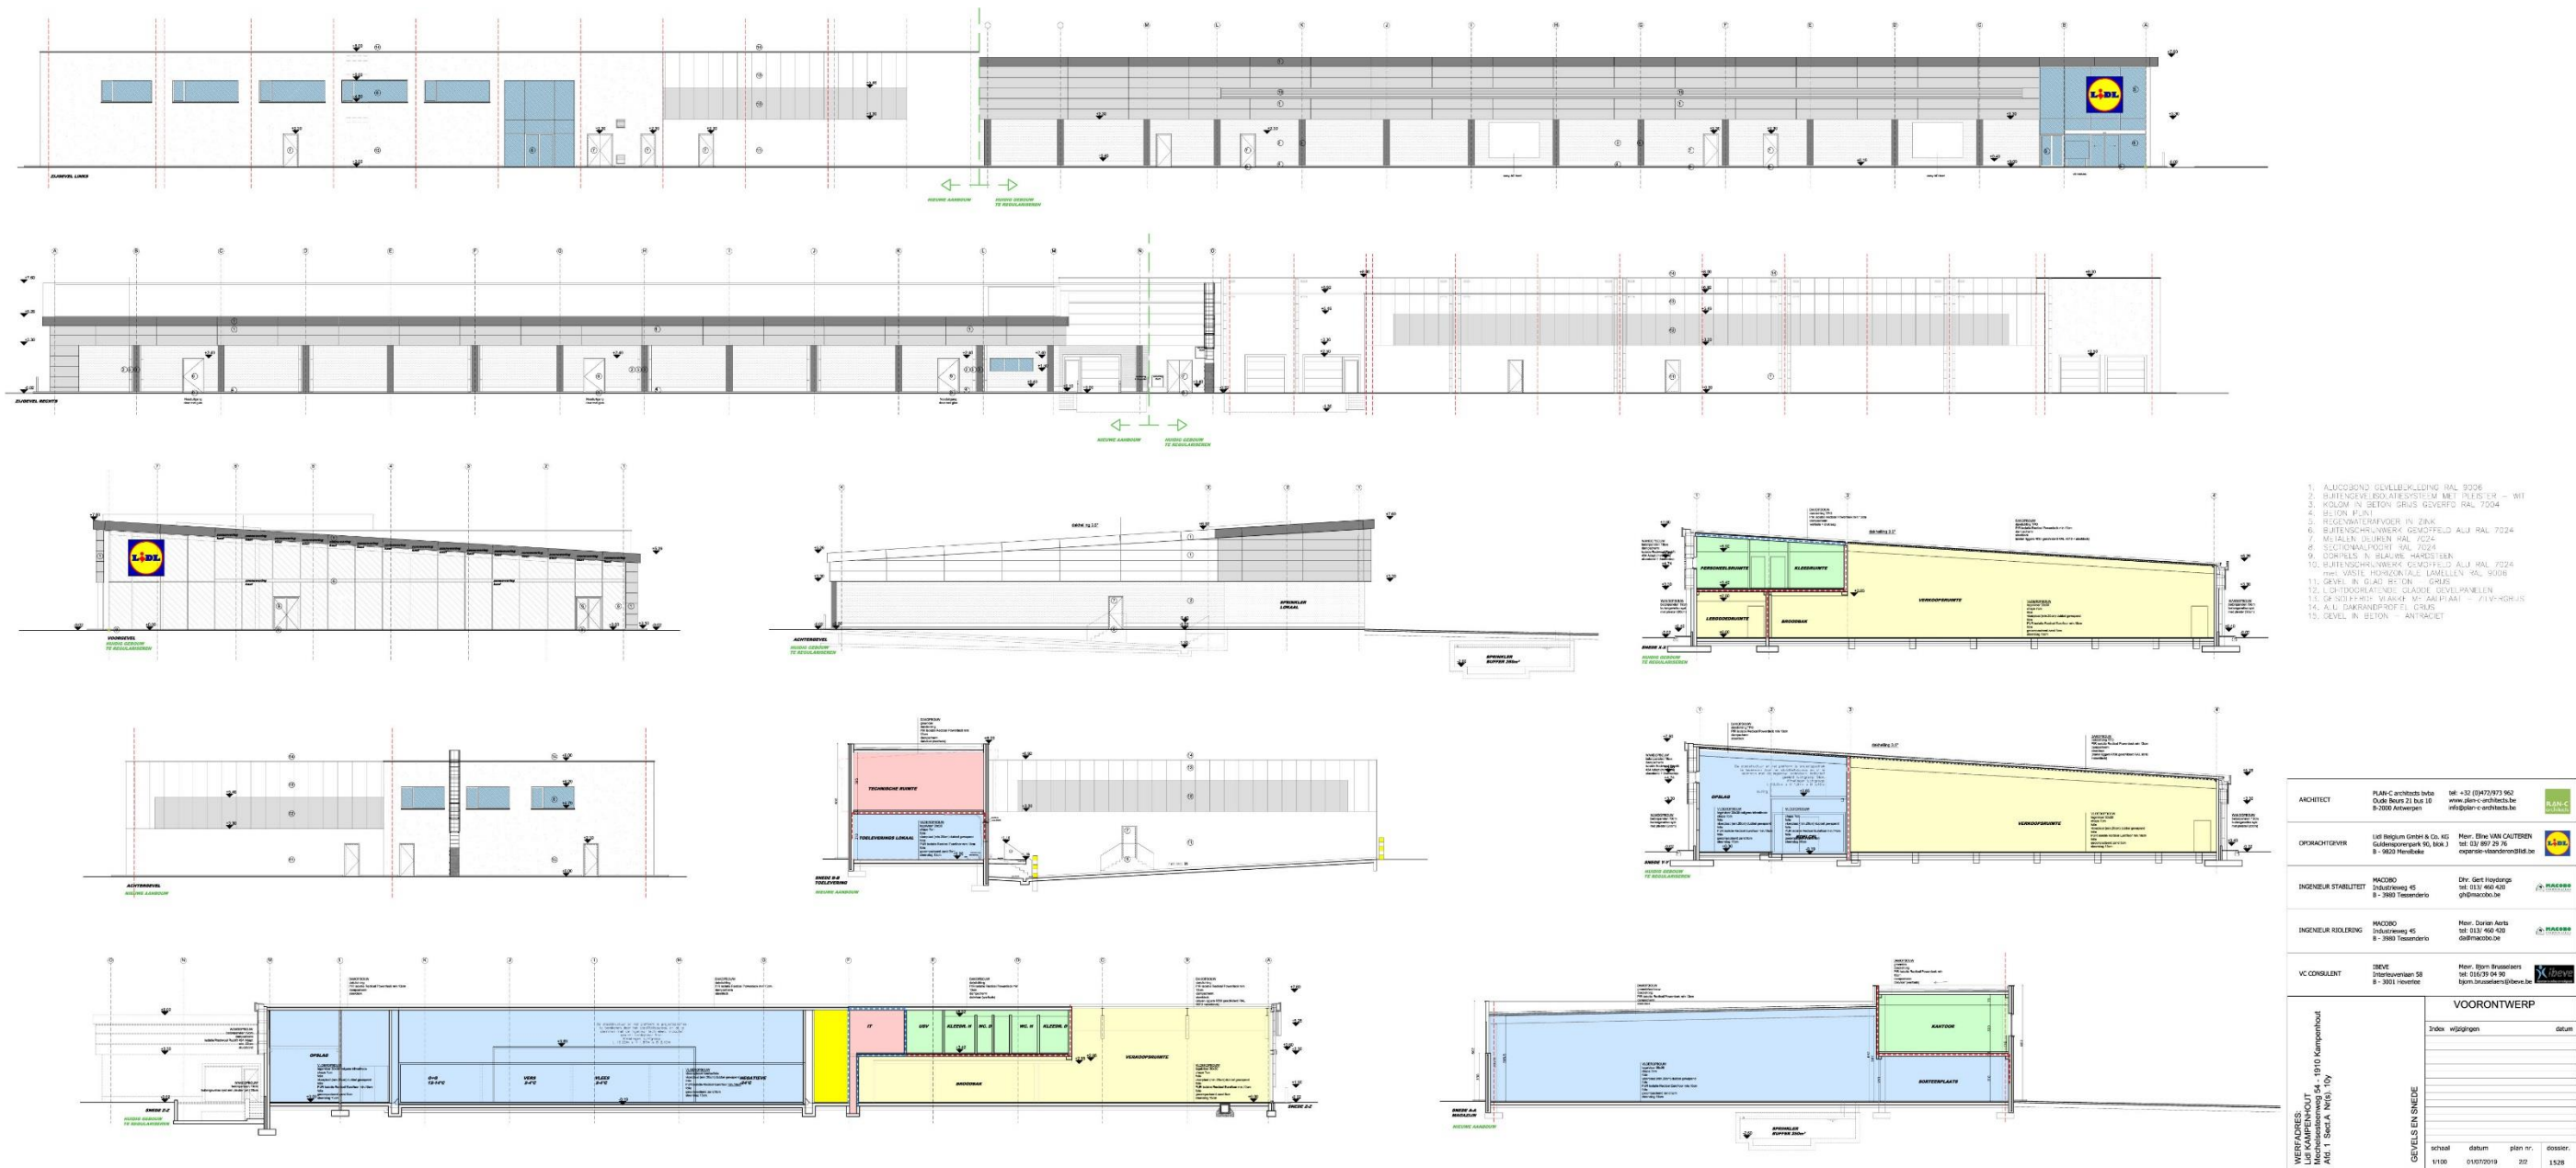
Plan van de gevels (PLAN-C architects bvba)
